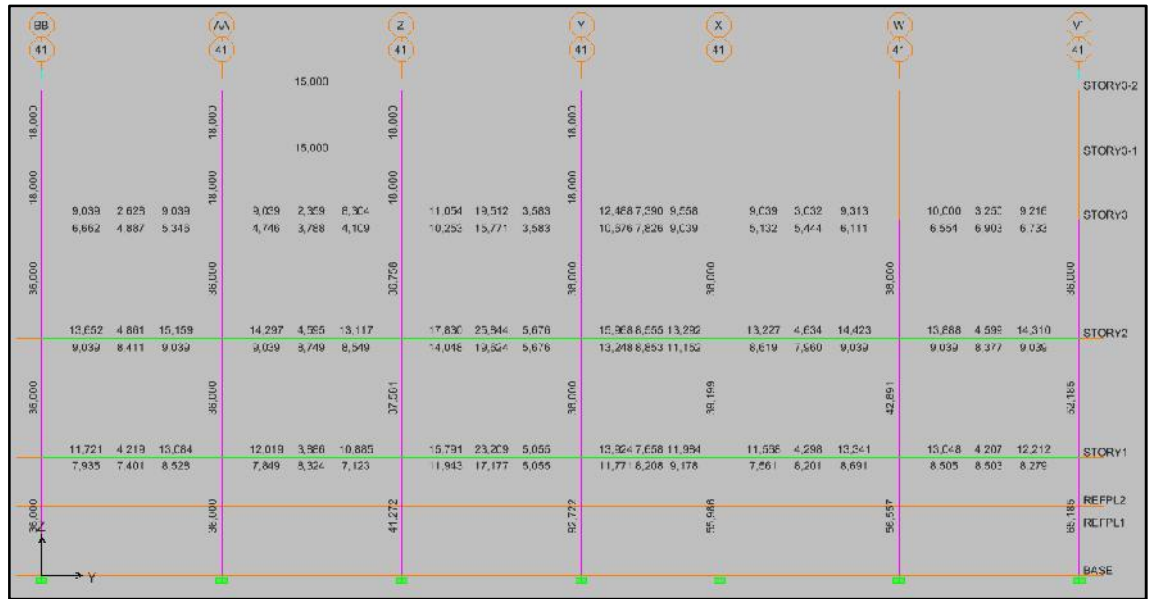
Acero en vigas pórtico 40, Consulta Externa II
